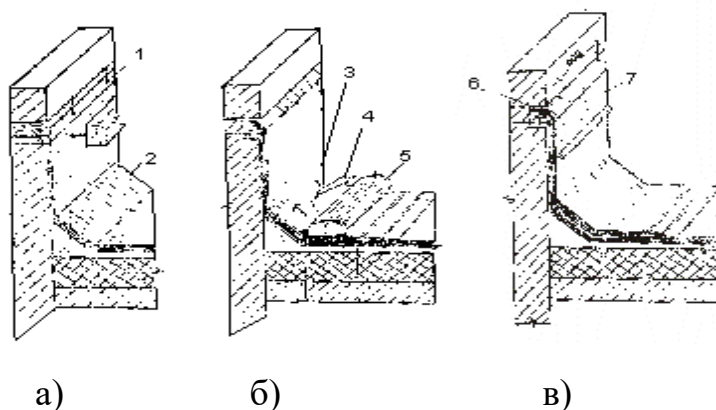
Последовательность устройства примыкания рулонной кровли к стене со штрабой
